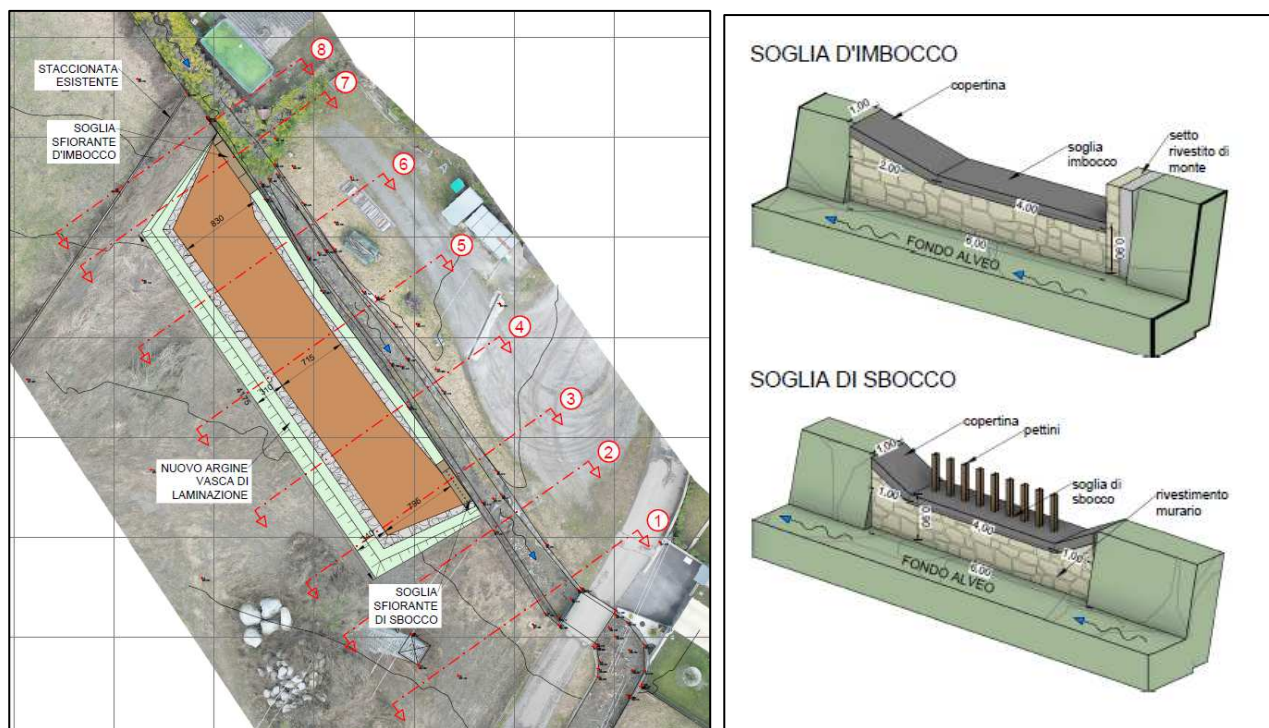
Stralcio della planimetria di progetto e delle soglie d'imbocco e di sbocco.
